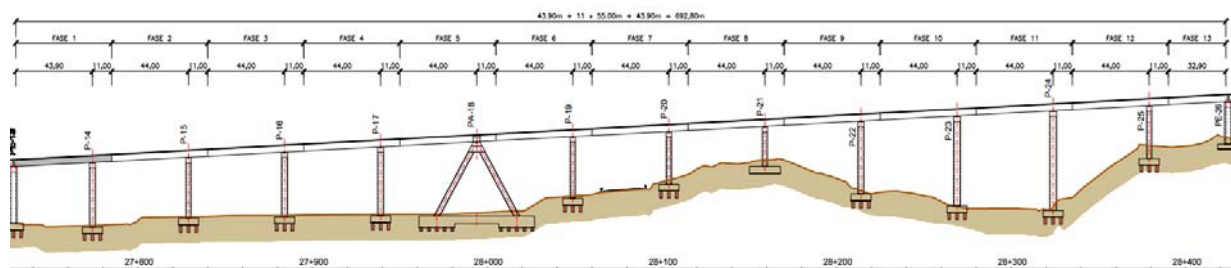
Alzado longitudinal tramo 2-2, con indicación de fases de ejecución del tablero
